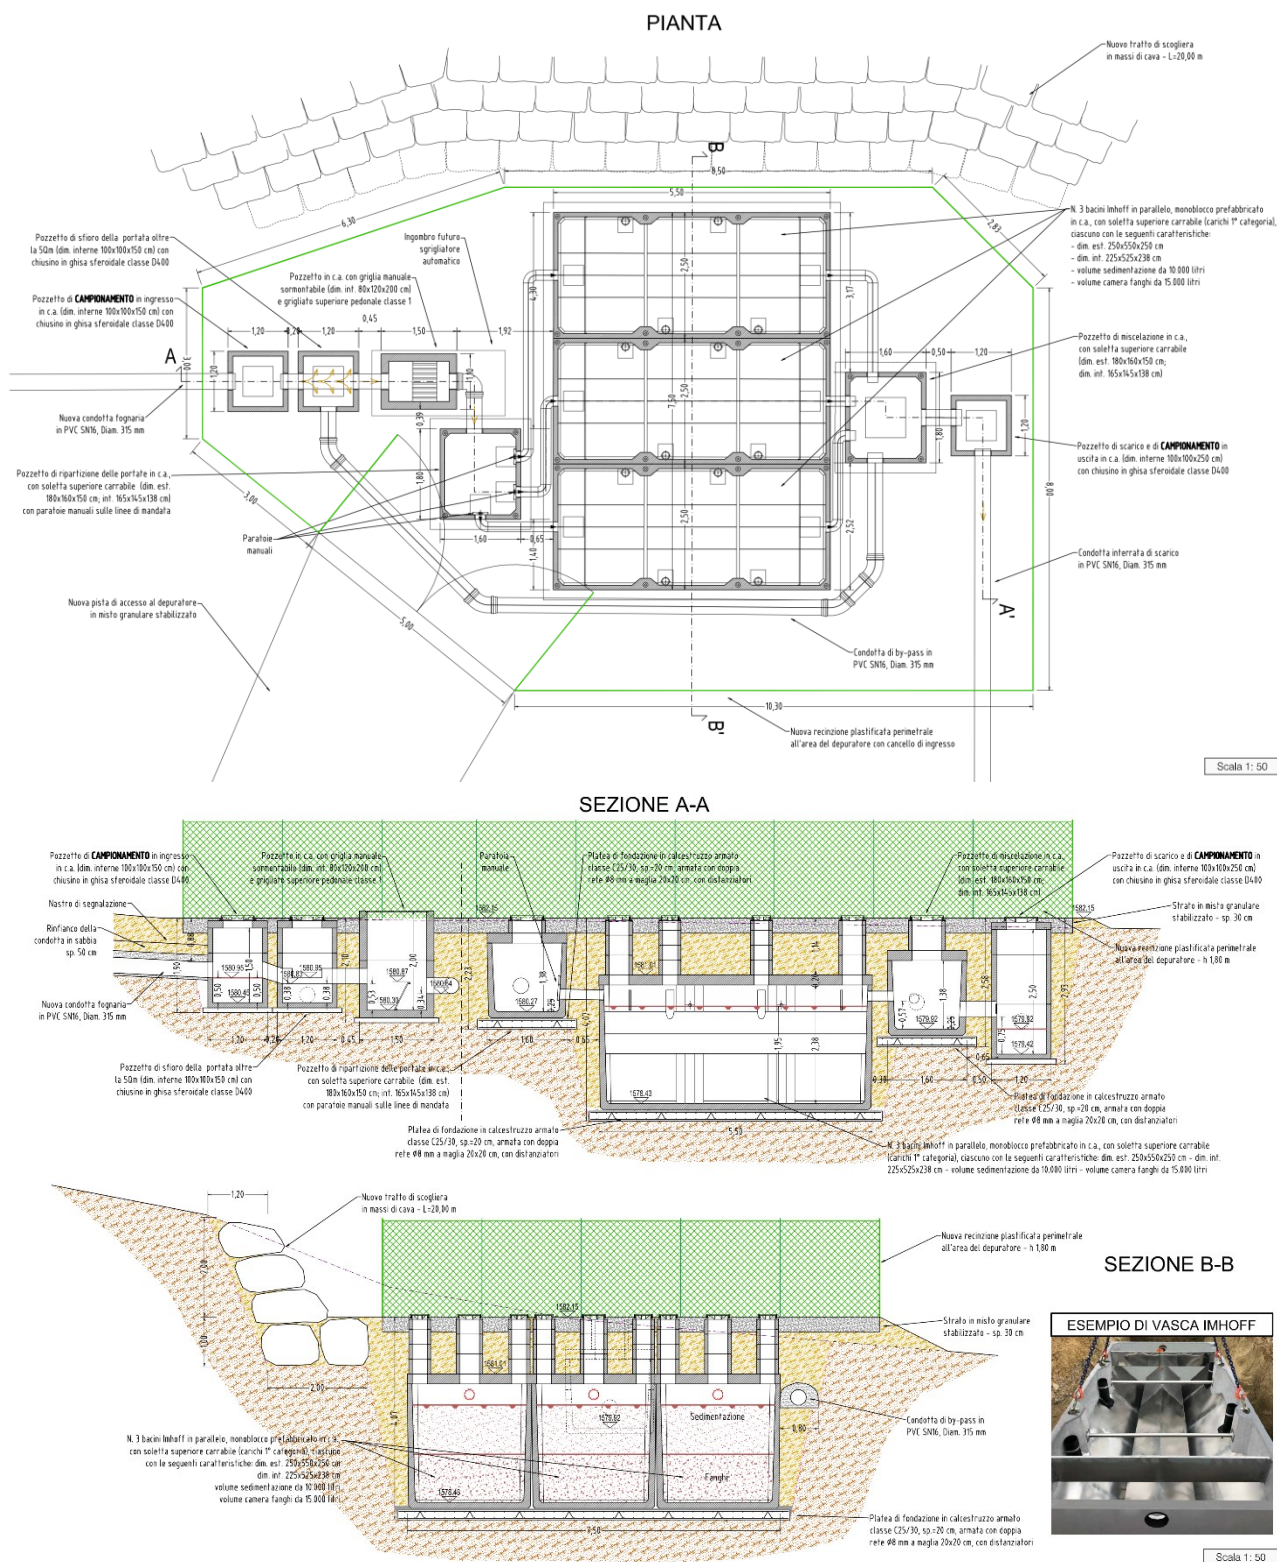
Planimetria e sezioni di progetto relative al nuovo impianto di depurazione.
